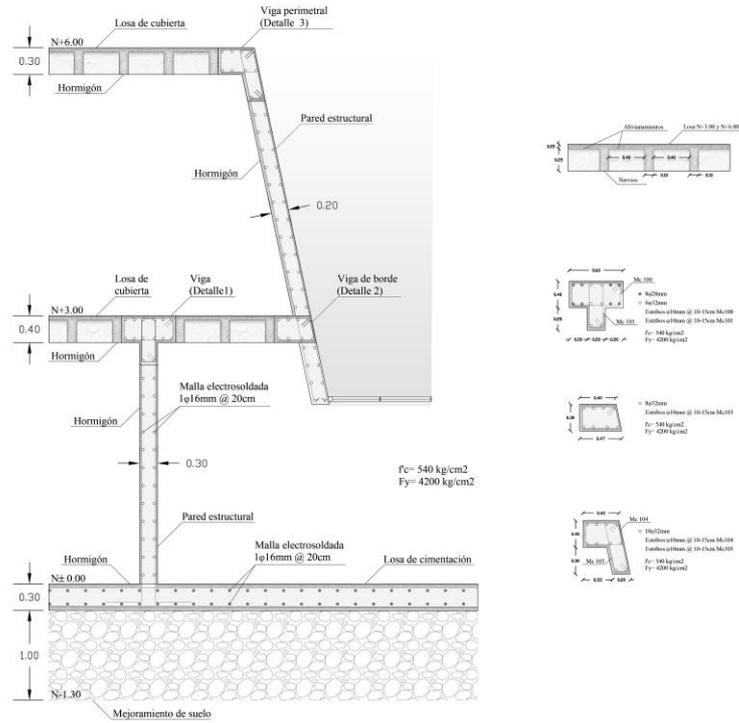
Detalle constructivo en corte. Elaboración propia
